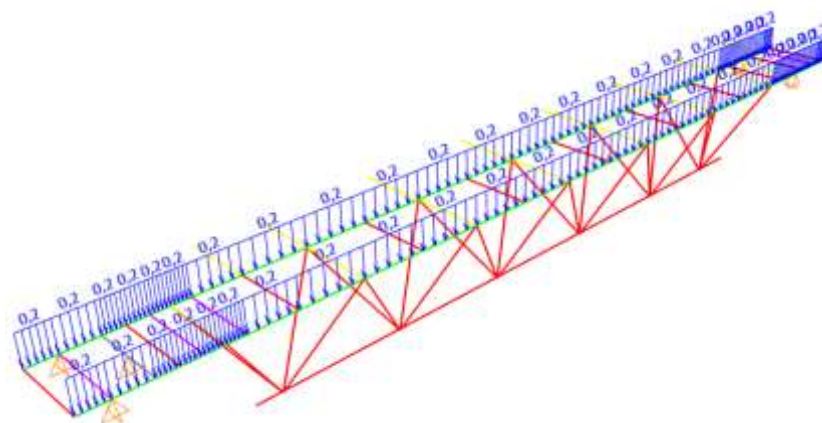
Beban *Handrail* yang diterima Struktur *Catwalk 12
